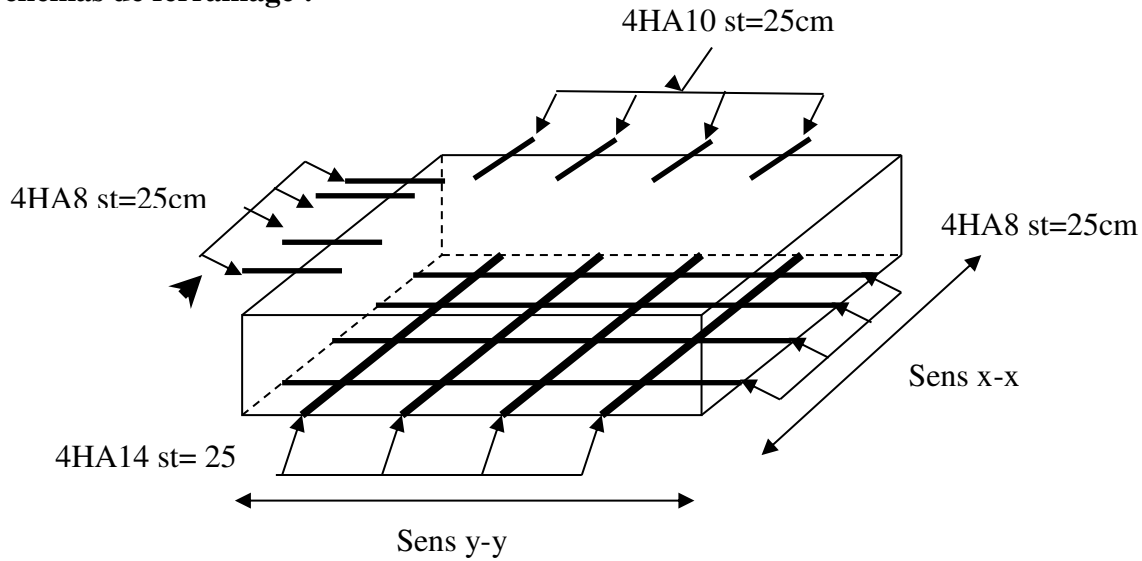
Schéma de ferrailage d'une dalle sur 3 appuis.
